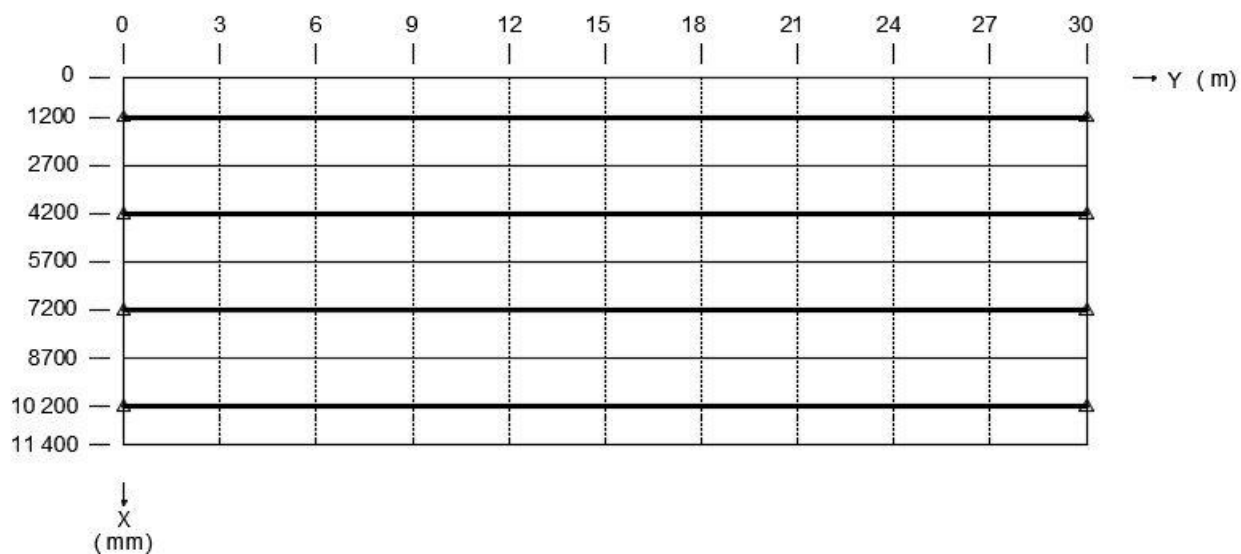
Vue en plan du pont modélisé sur CSI Bridge
